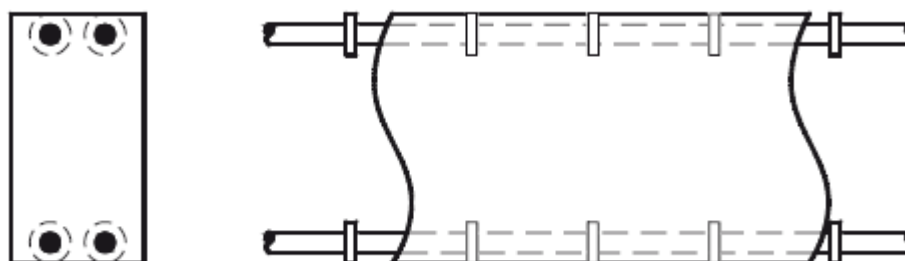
Конструкция армированной балки Х. Гранхольма
